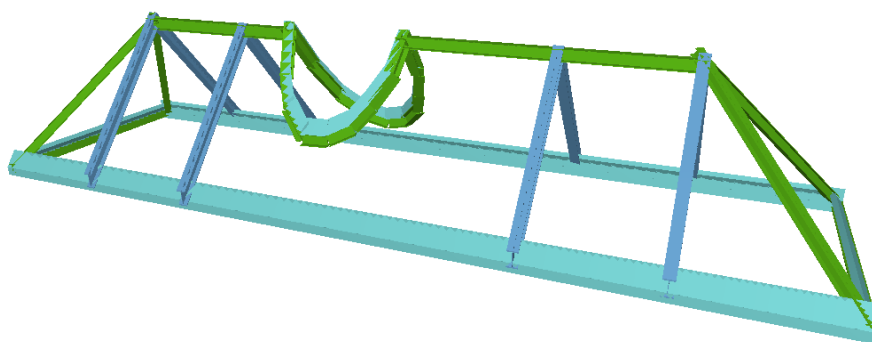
Vigas inclinadas da cobertura (Fonte: Cypecad, 2015)
